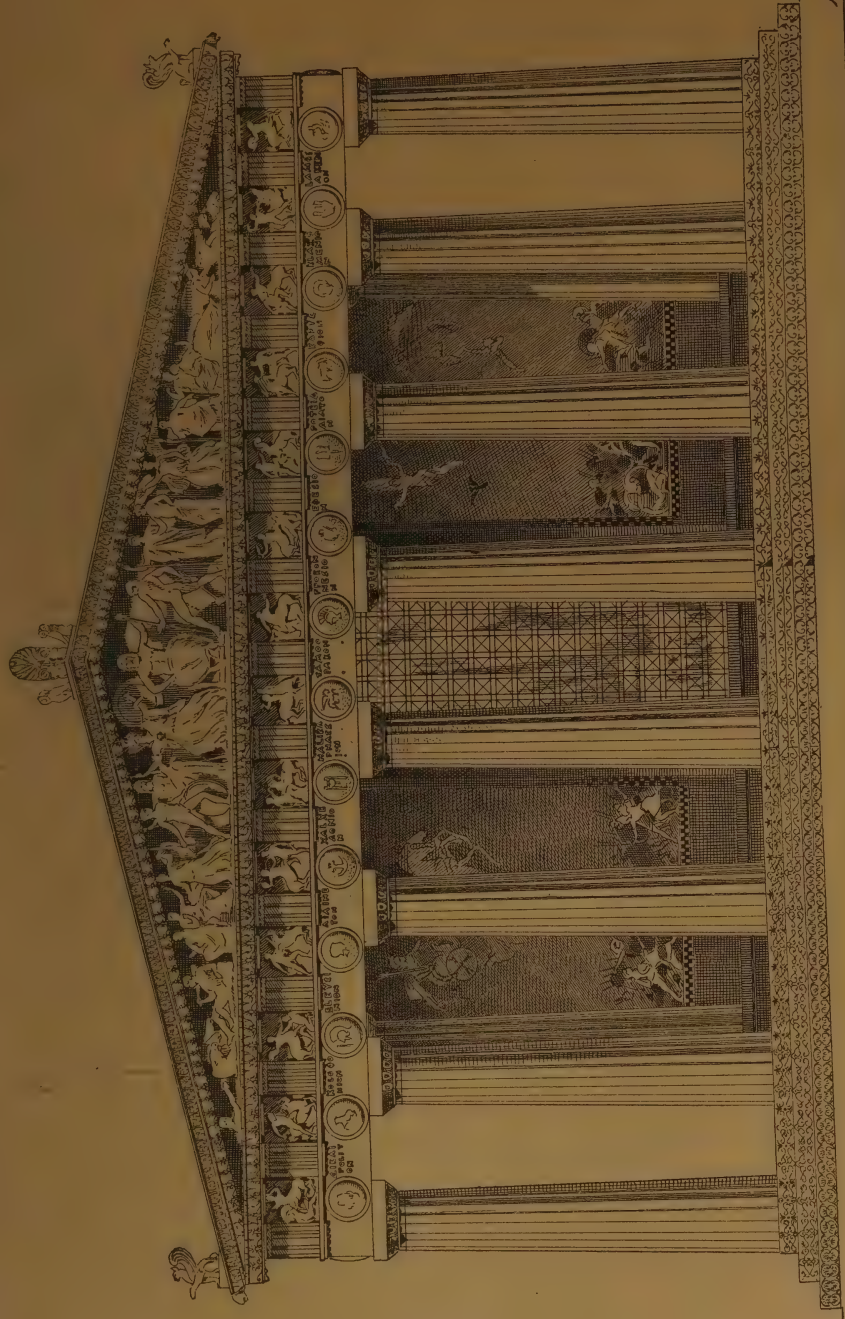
FAÇADE PRINCIPALE DU PARTHÉNON, RESTAURATION DE M. LOVIOT.
